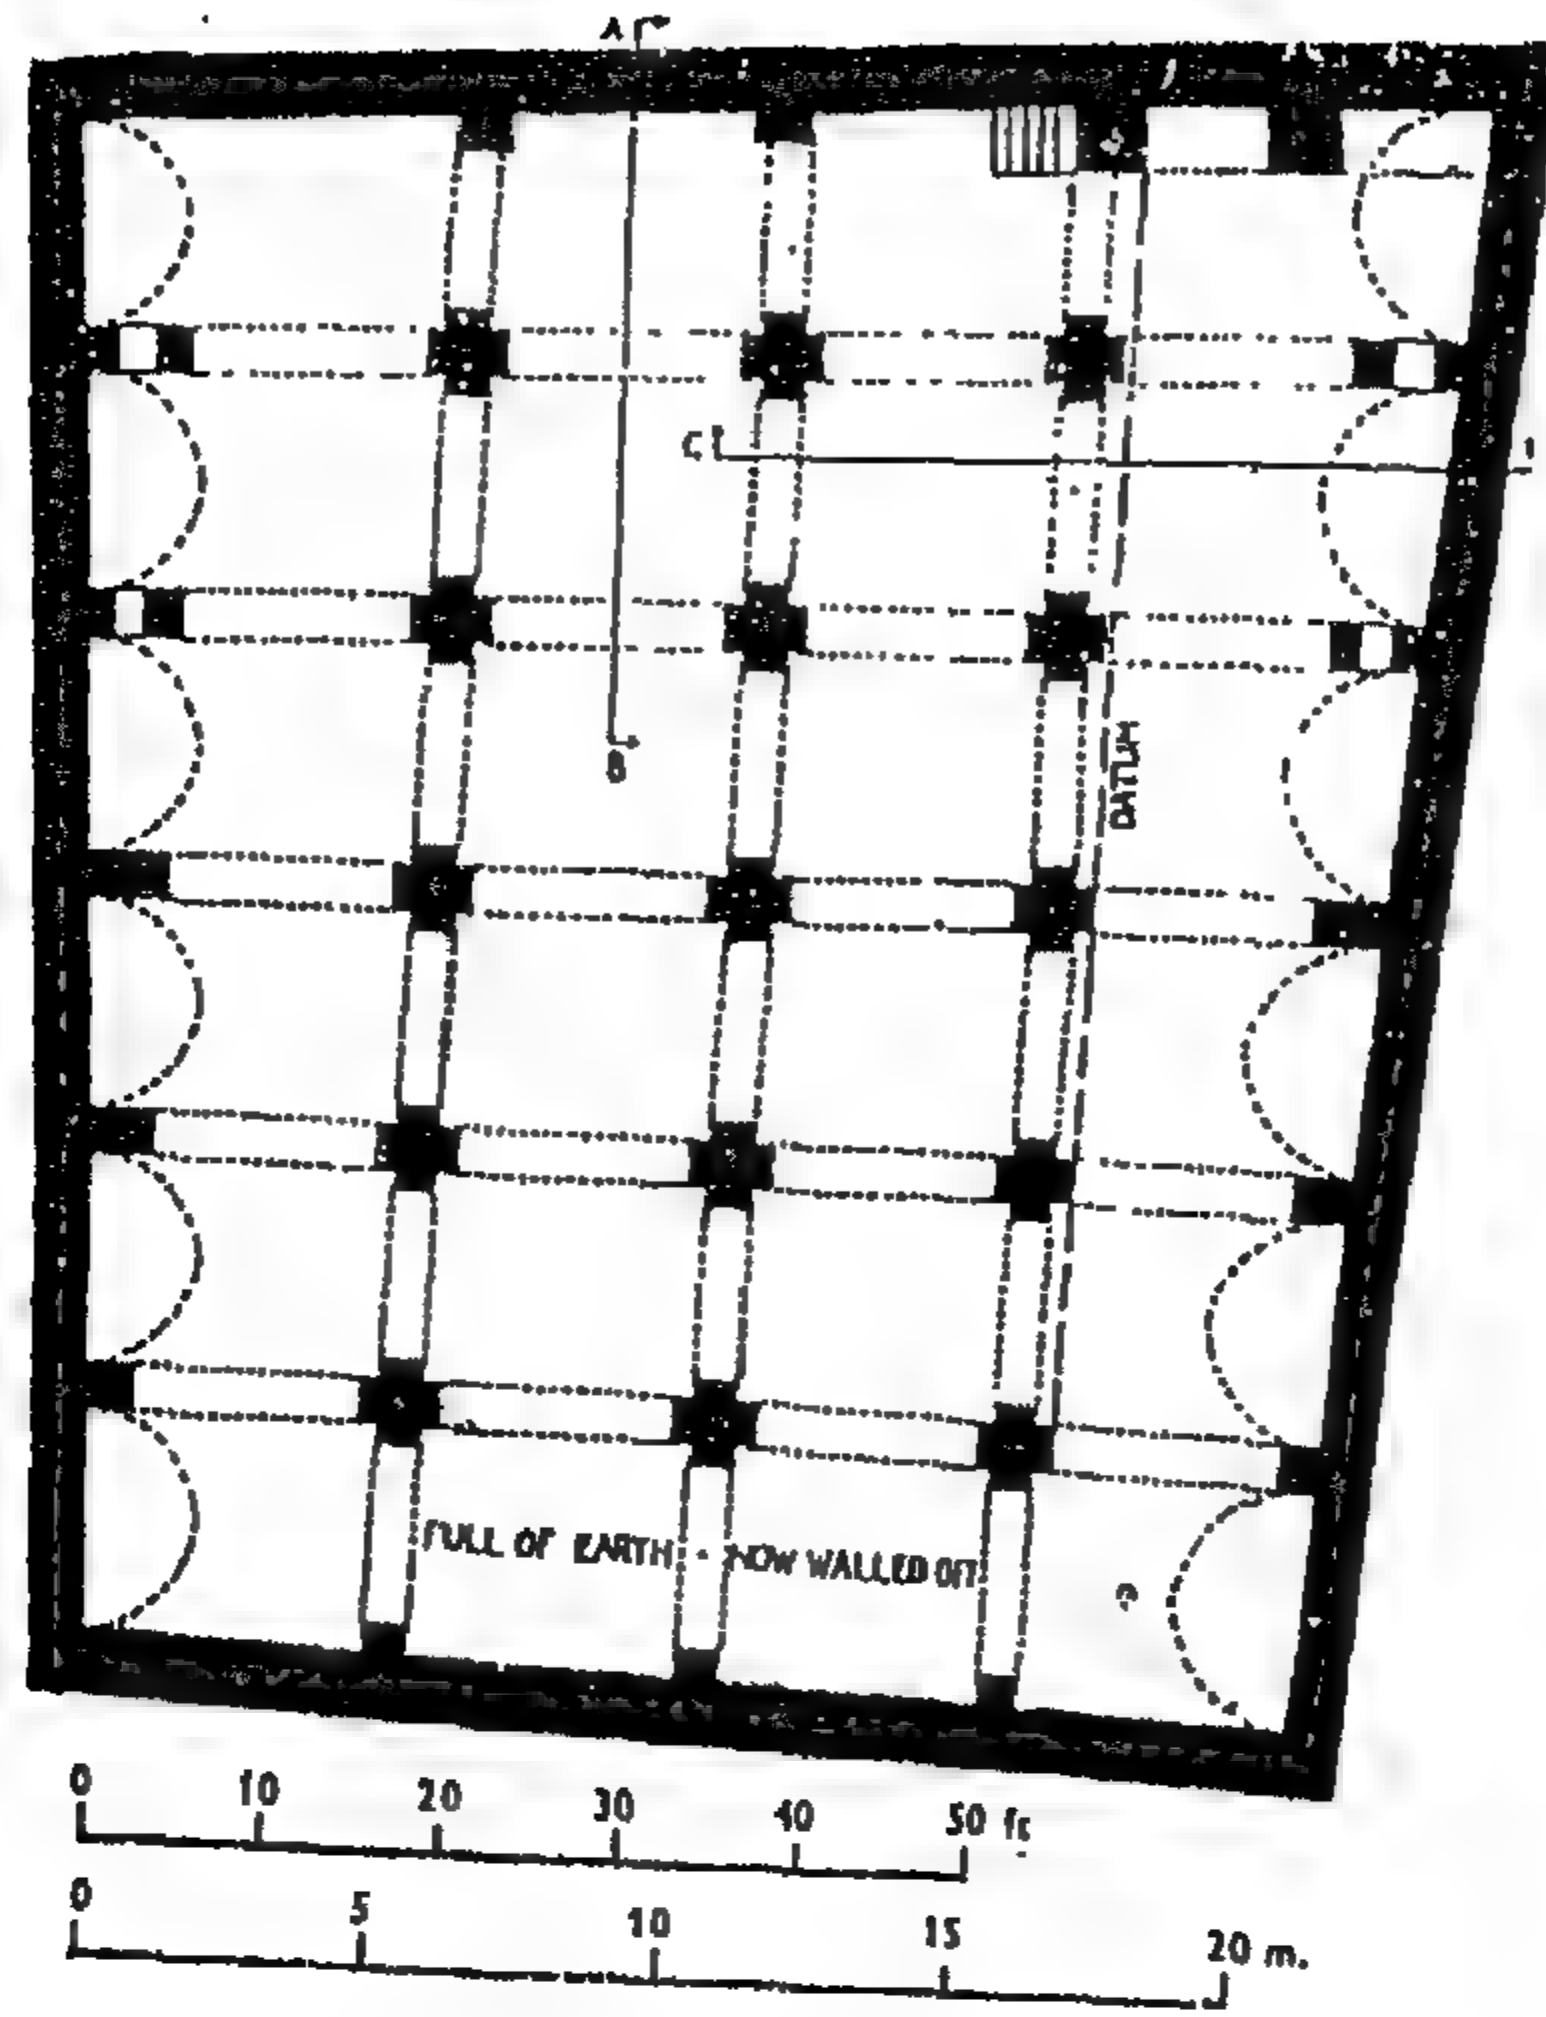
مسقط أفقي لمسجد قصر جبل سيس . (عن : كرينزول) .
